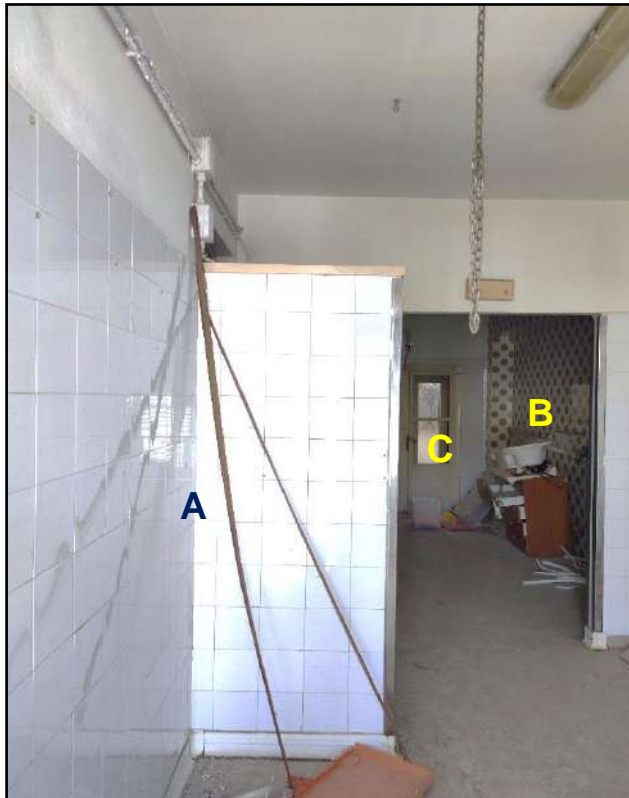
Camera 1: pareti con piastrelle ceramiche cm. 20 x 20 - h = m.2,30
